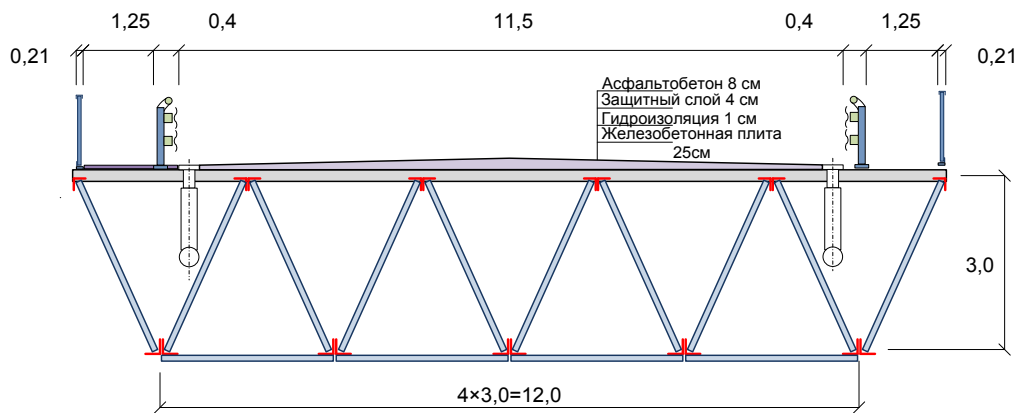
Поперечний переріз прогонової будови з просторовою решіткою
